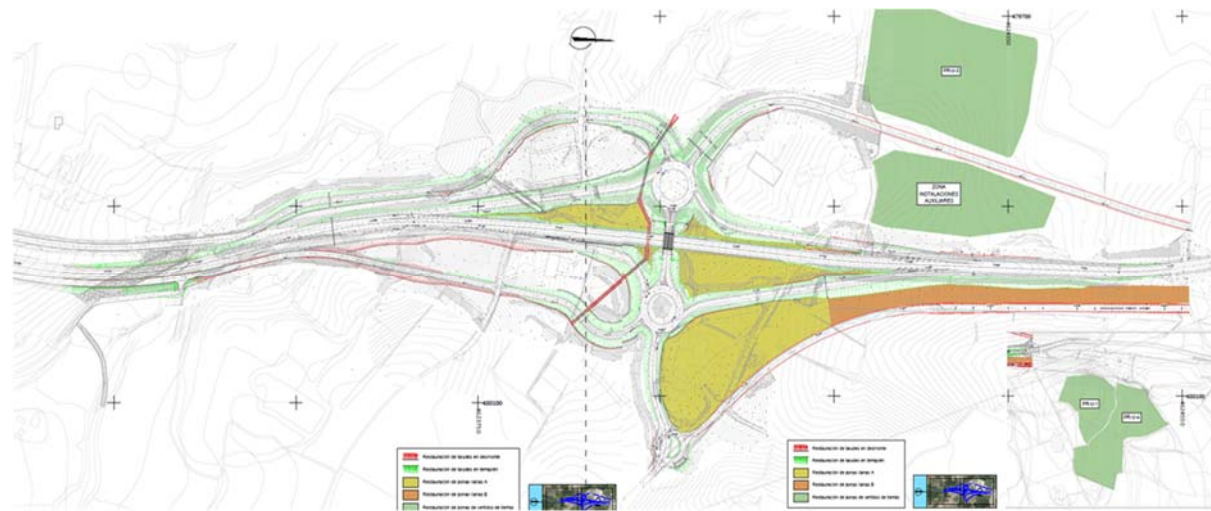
Detalle de conexión con el tramo previo. Proyecto de Clave:12-GI-3740
